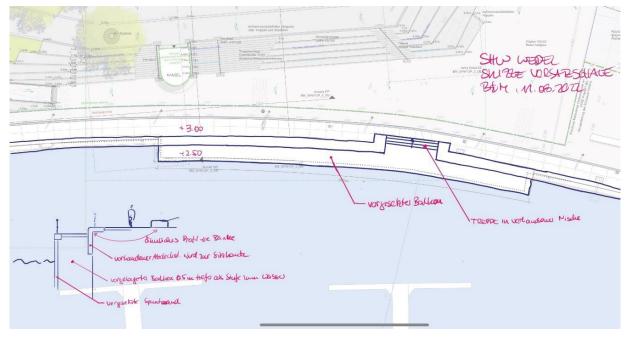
Variante 1A: Balkon (Ideenskizze. Lageplan und Querschnitt)
